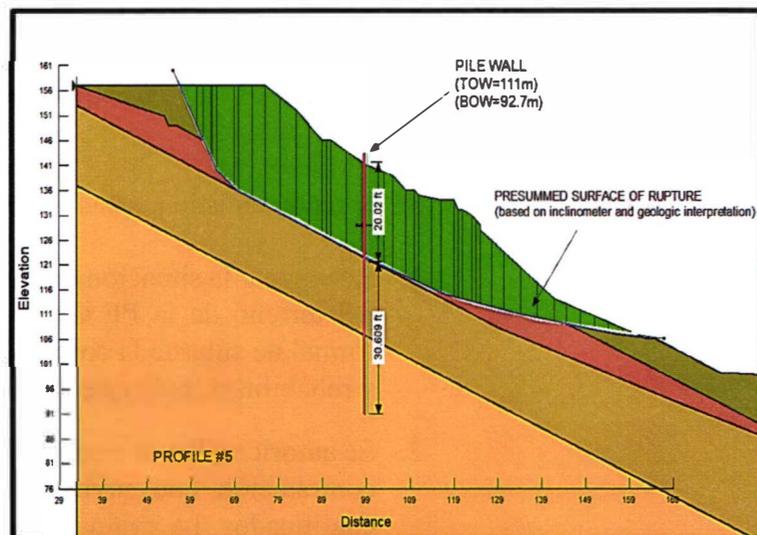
Perfil esquemático del suelo con la línea de pilotes en la cota de elevación de 111 metros.
